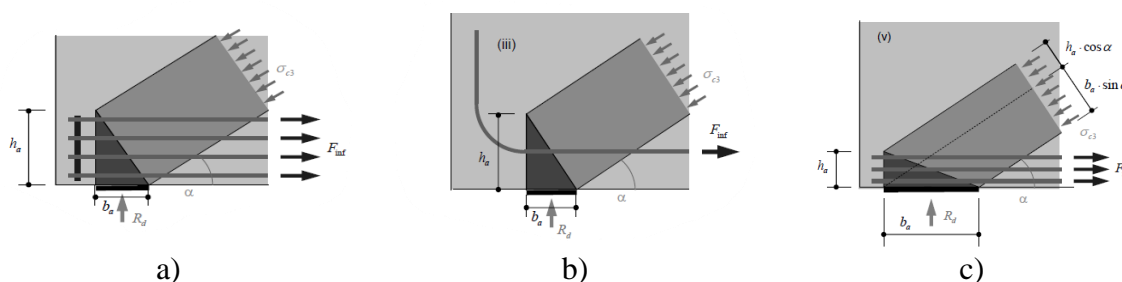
Configurações típicas de ancoragens de armaduras. a) armaduras em U; b) armadura em gancho; c) armaduras encabeçadas; Fonte: (ETH Zurich, 2020a)
